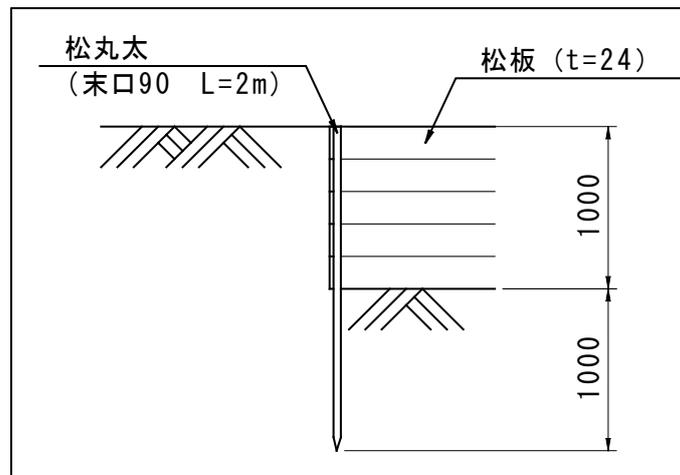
(2) 沈砂池の構造 (断面図)
